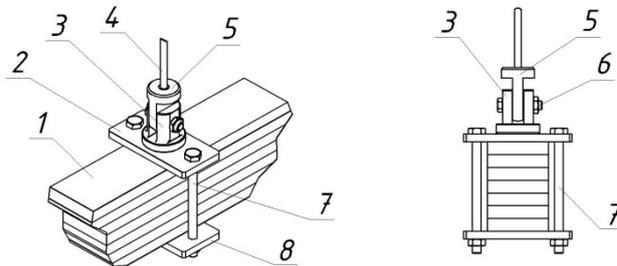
Узел примыкания подвески к балке: 1 – балка; 2 – верхняя планка; 3 – серьга; 4 – подвеска; 5 – проушина; 6 – вал; 7 – болты; 8 – нижняя планка
